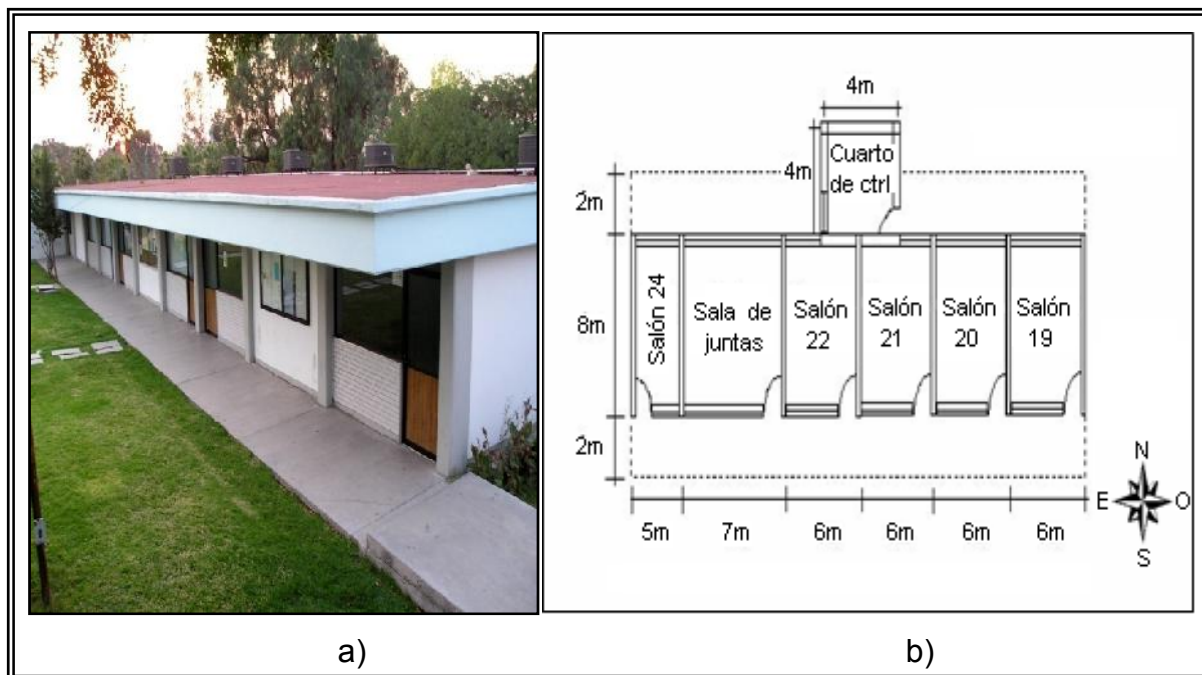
a) Edificio sujeto a experimentación. b) Vista de planta del edificio (Ríos-Moreno, et al., 2007).
